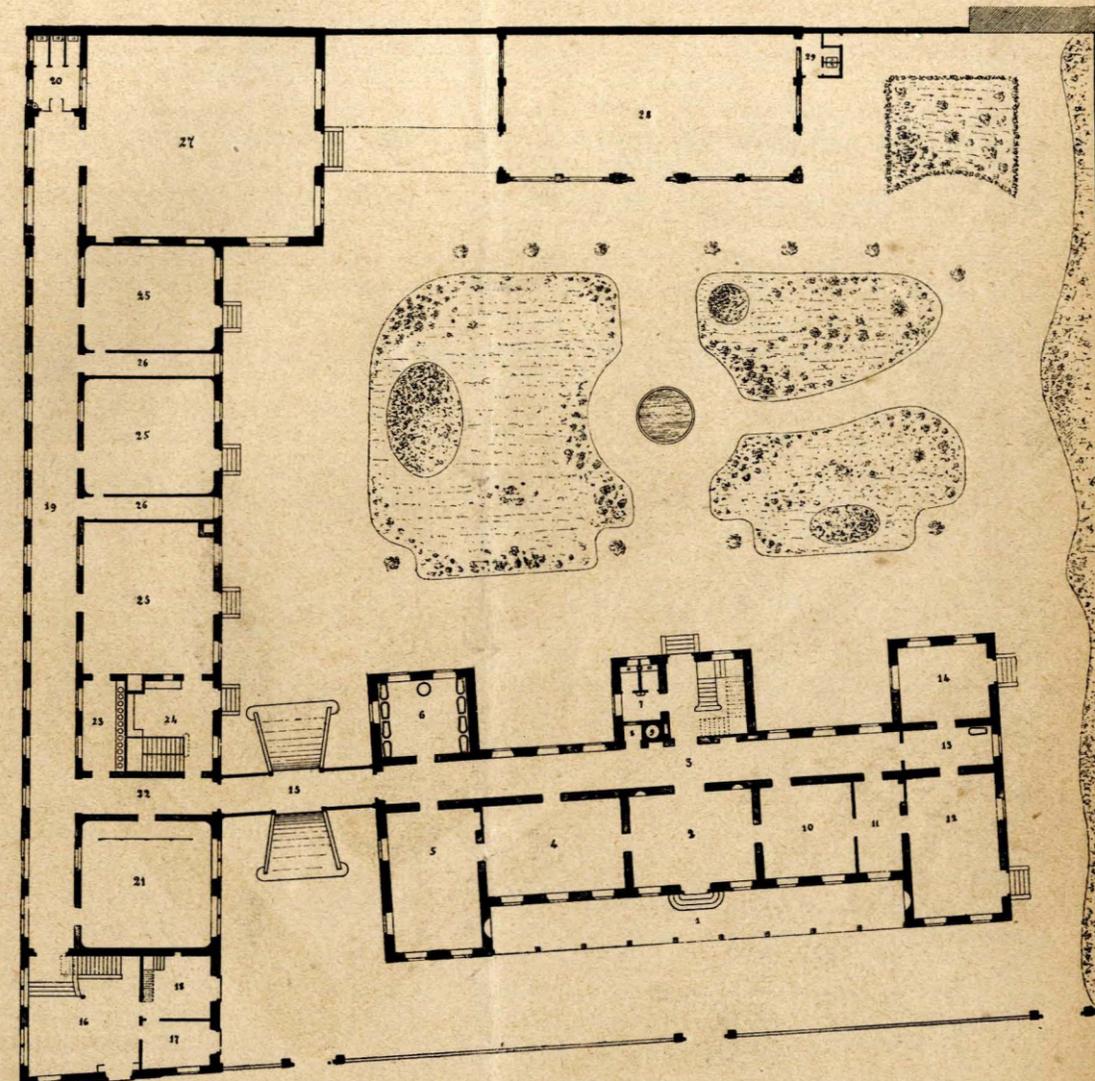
Pianta generale del piano terreno. Scala di 1/480
